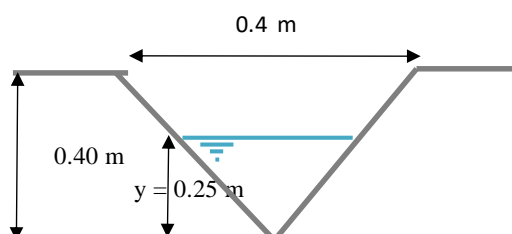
Dimensiones para cuneta, diseño con T=25 años
